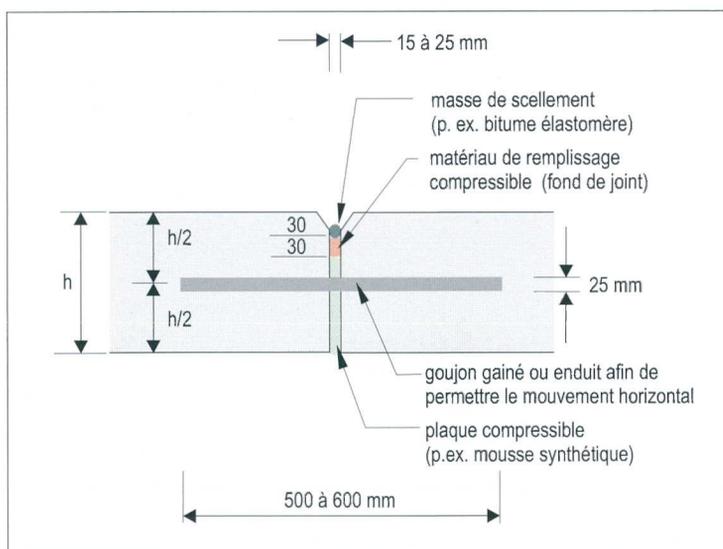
Exemple de joint de structure – Goujon placé dans un joint de tassement
